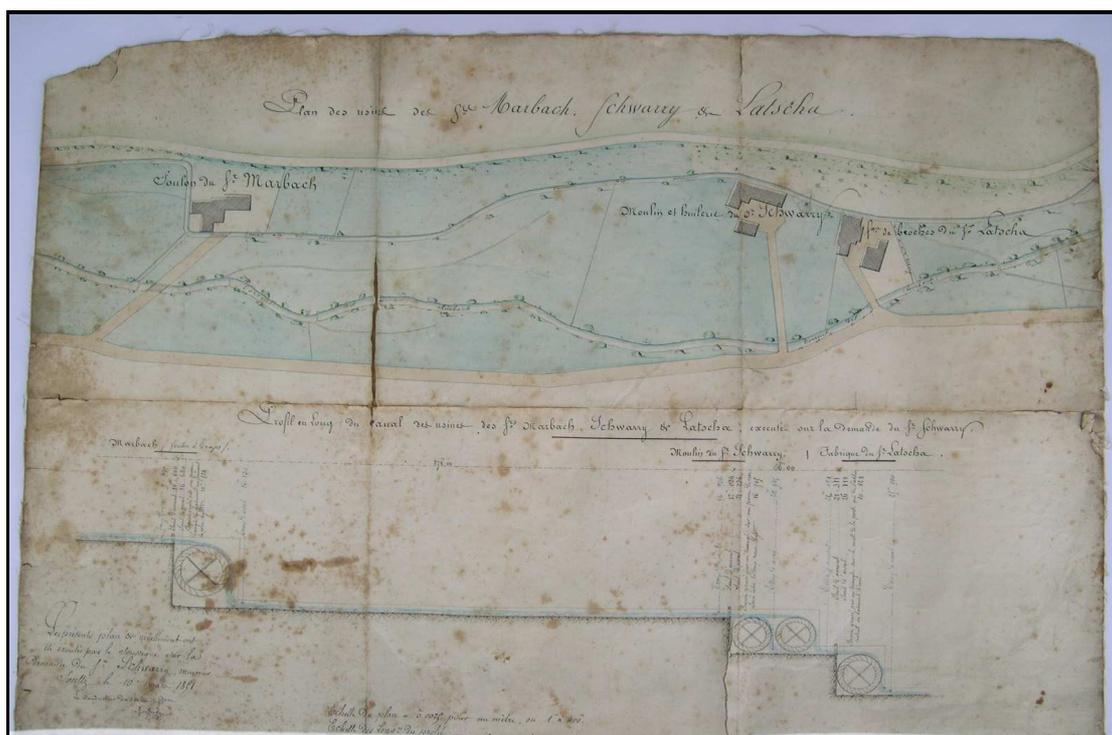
Plan du foulon, du moulin et de la fabrique Latscha en 1851 (photo R.Baecher).
